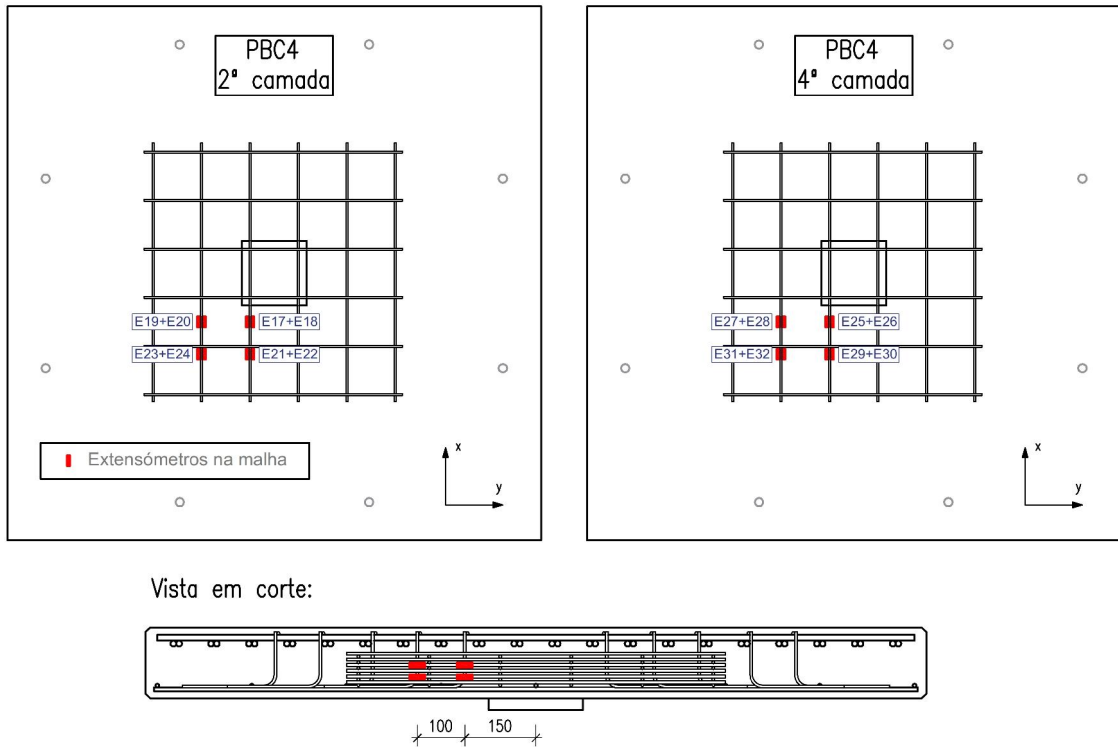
Localização e numeração dos extensômetros nas armaduras do tipo malha da Laje PBC4.
